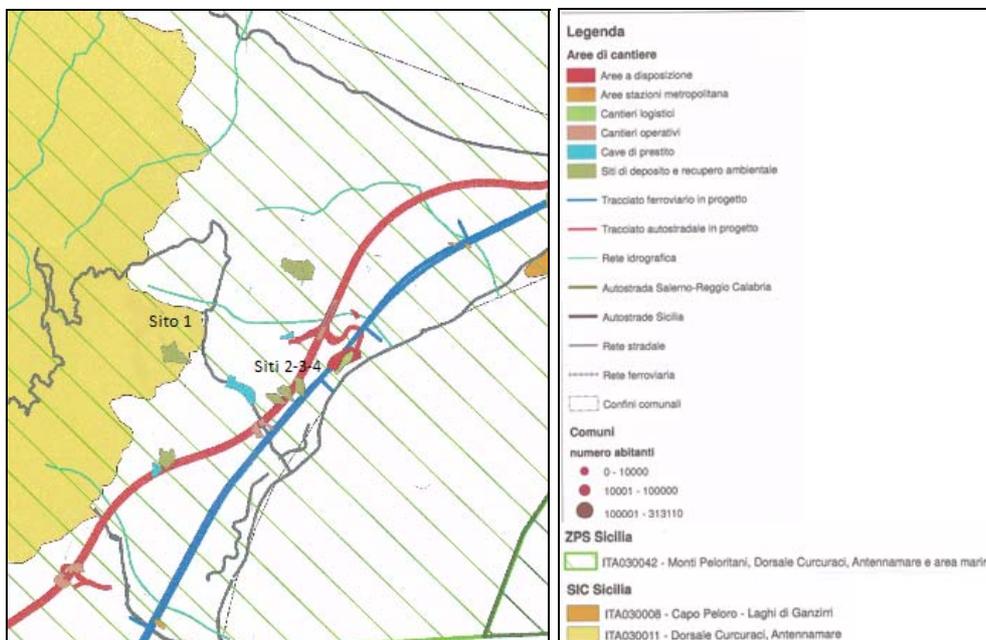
Planimetria con indicazione SIC/ZPS e principali elementi di progetto
